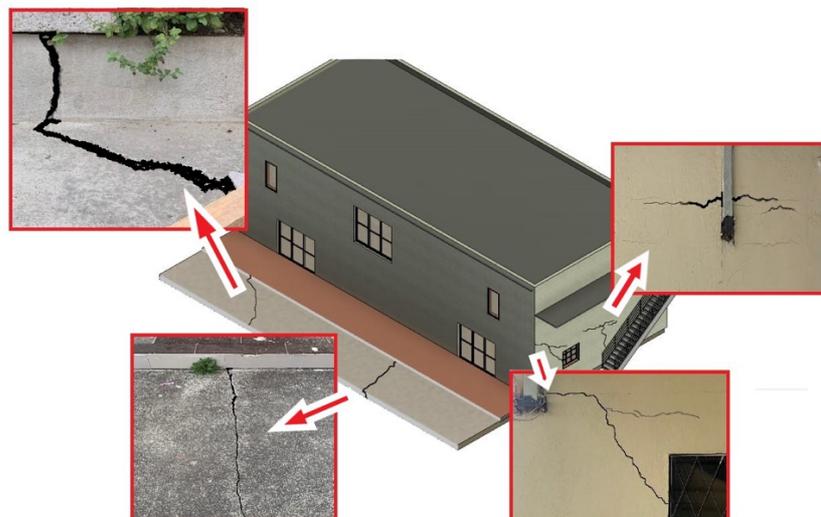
Casa 13. Detalle de fisuras de dos niveles.
